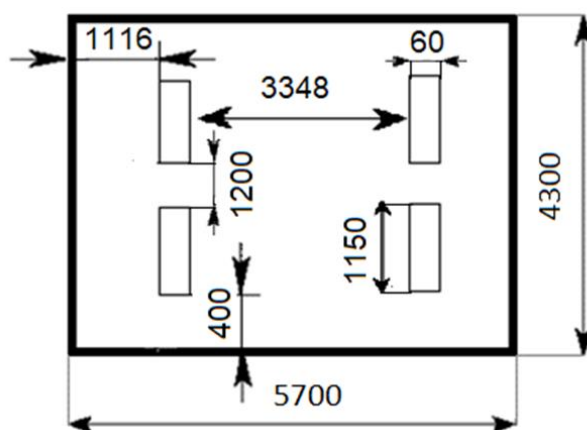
Схема размещения светильников в помещении Индекс помещения определяется по формуле:
